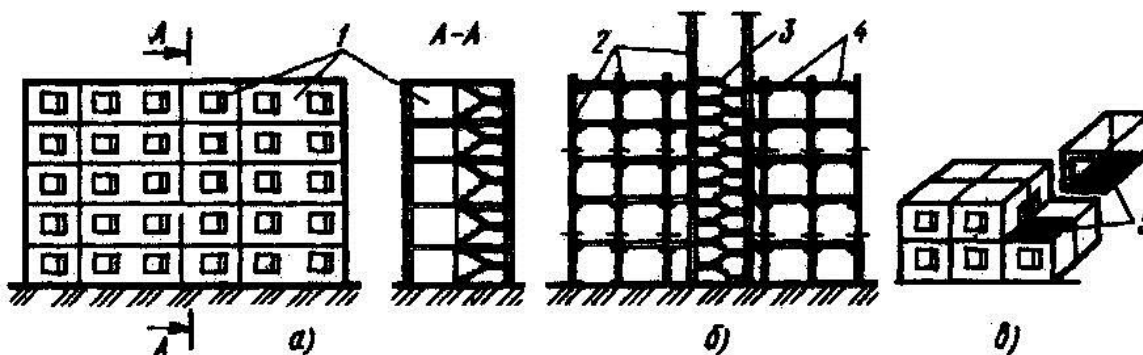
Конструктивные схемы зданий [34]: а – крупнопанельного с несущими стенами, б – каркасного, в – объемно-блочного: 1 – панели стен, 2 – колонны, 3 – лестницы, 4 – ригели, 5 – объемный блок
